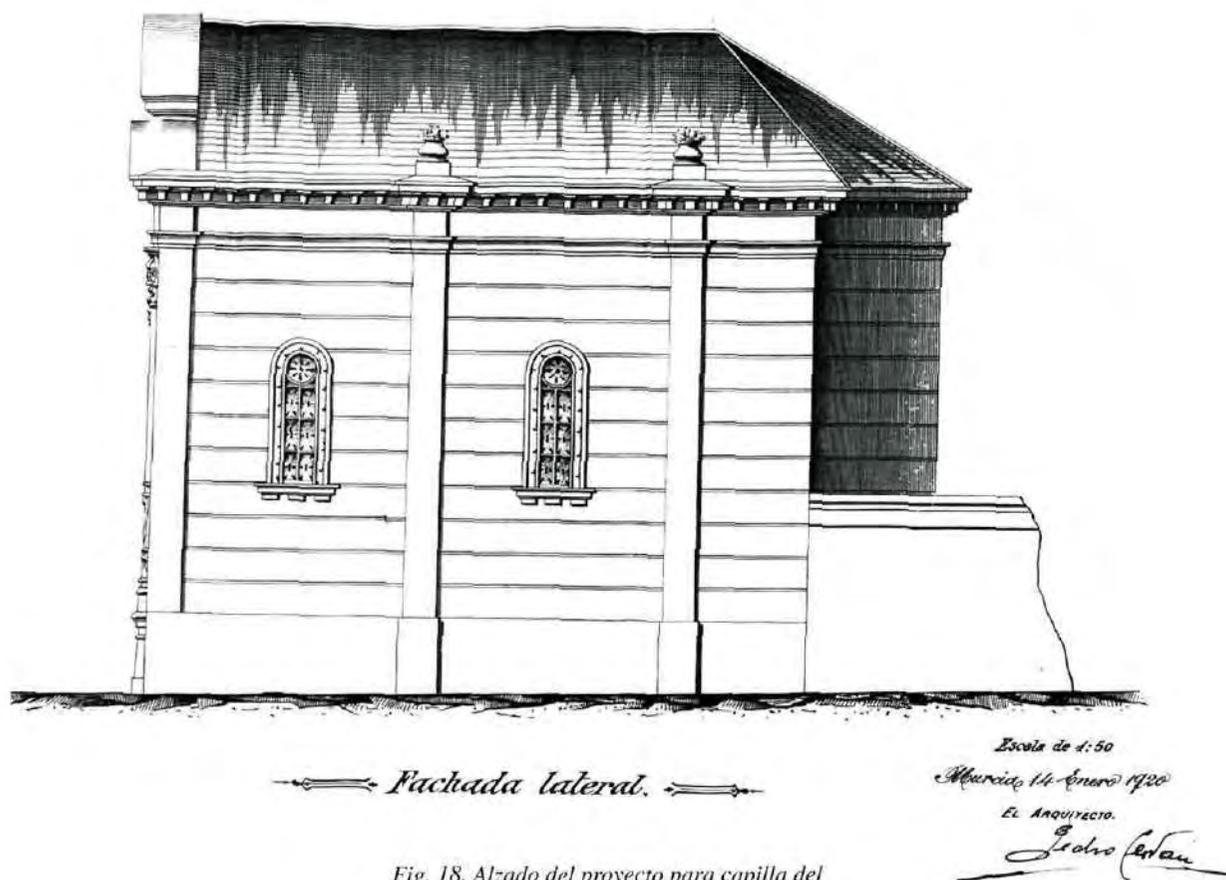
Alzado del proyecto para capilla del cementerio de San Clemente. Pedro Cerdán. 1920
